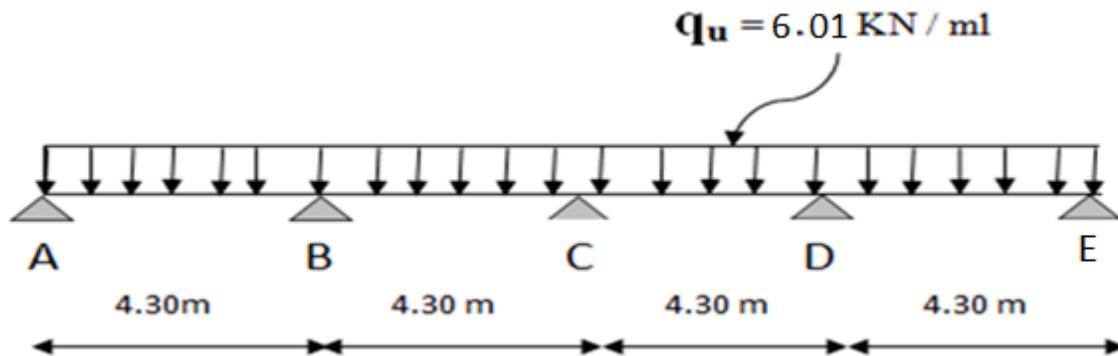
Schéma statique de la poutre continue reposant sur cinq appuis.
